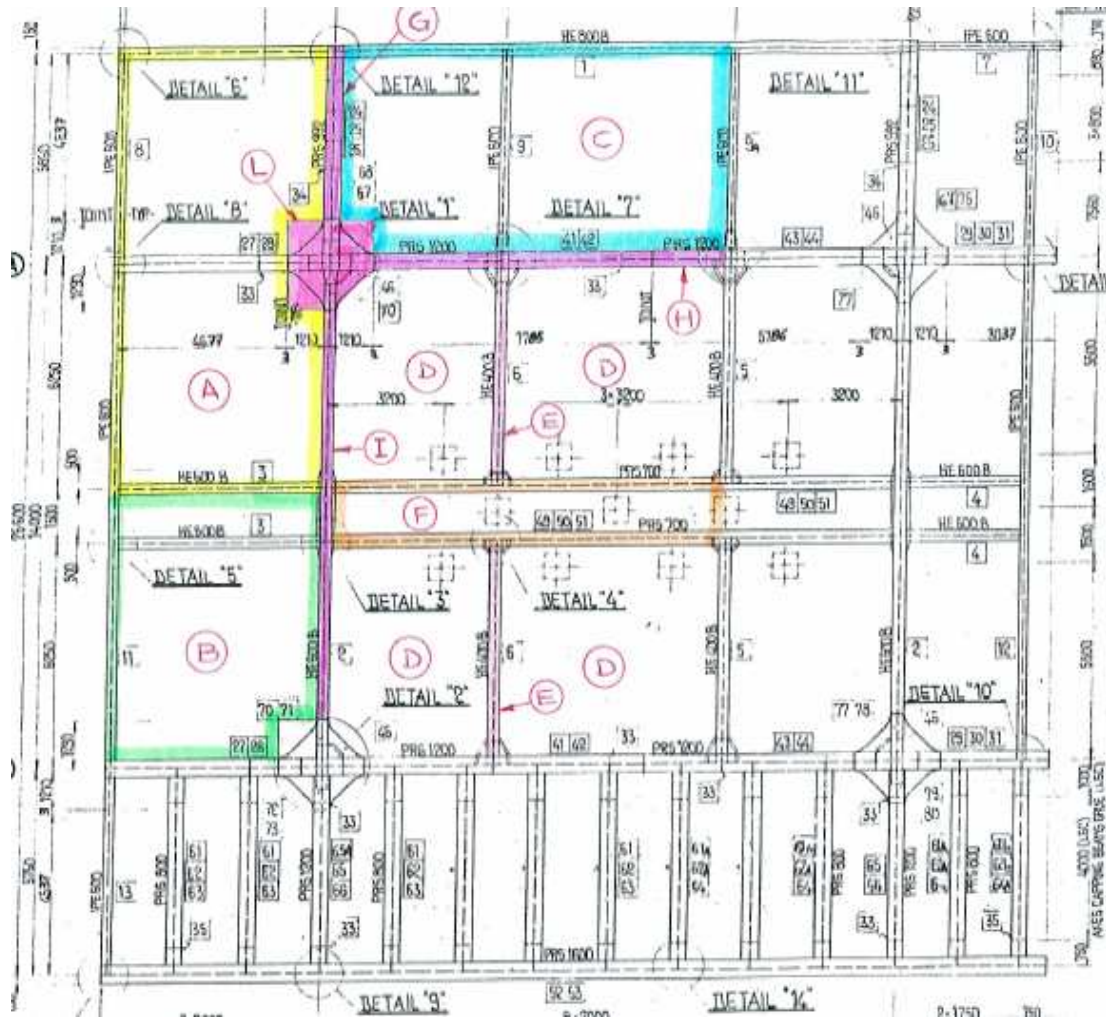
Sketch planimetria strutture esistenti da rimuovere
